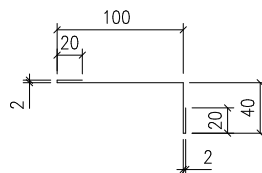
Rive contre mur en pose verticale (avec fixations cachées en extrémité)
